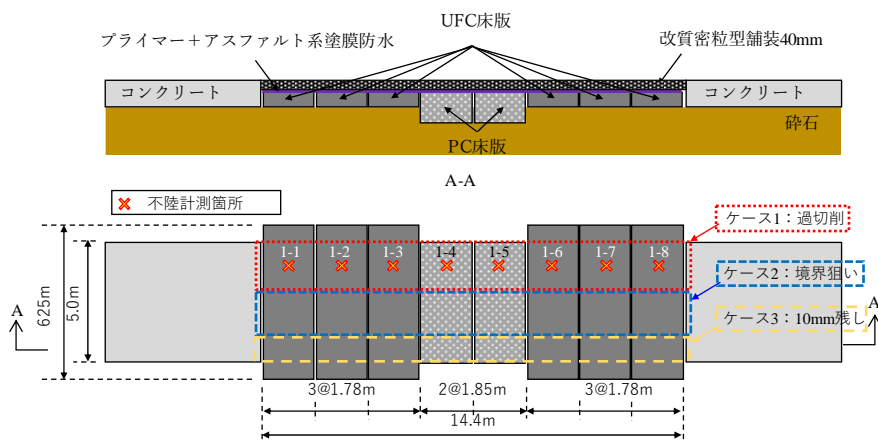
試験体と計測箇所のイメージ図(上段:断面図, 下段:平面図)
